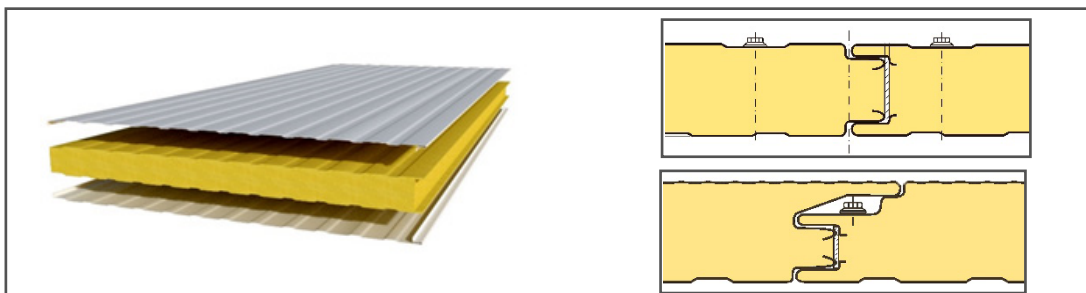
Panel sándwich para fachada con chapas exteriores metálicas onduladas y núcleo aislante de poliuretano expandido de densidad media 40 kg/m<sup>3</sup> (izquierda). Tipos de unión (A) con tornillería vista. (B) con tornillería oculta (derecha). Fuente: Patec.org.
